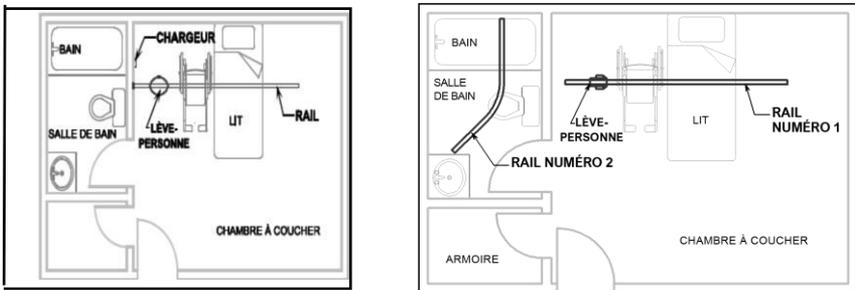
exemples de plans d'installation d'un système de lève-personne.
